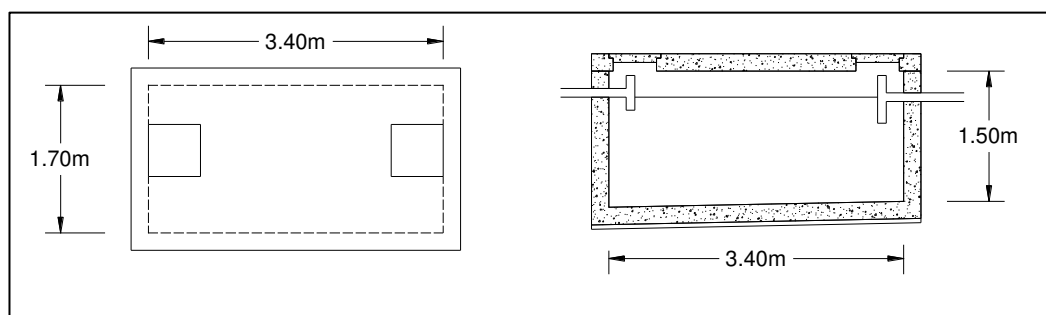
Dimensiones internas en planta y en corte del tanque séptico
